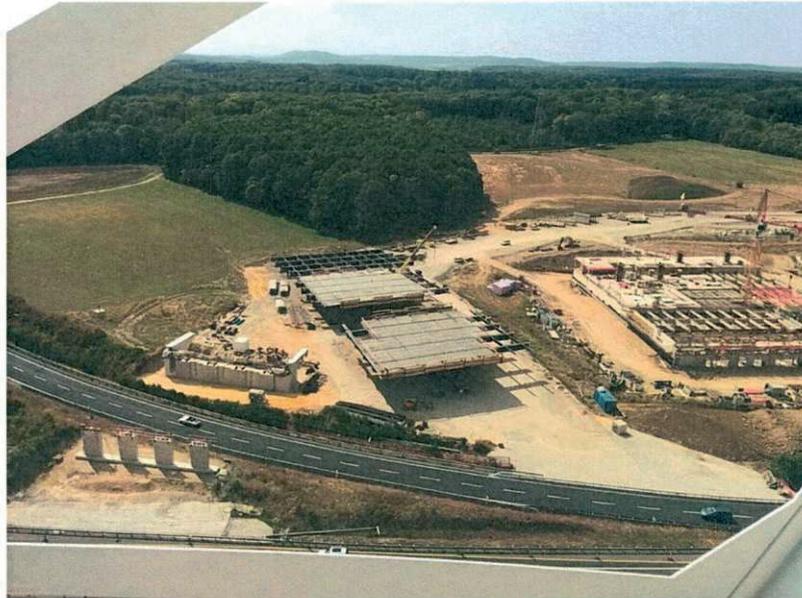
Ouvrage d'art OA17 – Kamag en place avant le montage du premier tronçon de l'ouvrage
